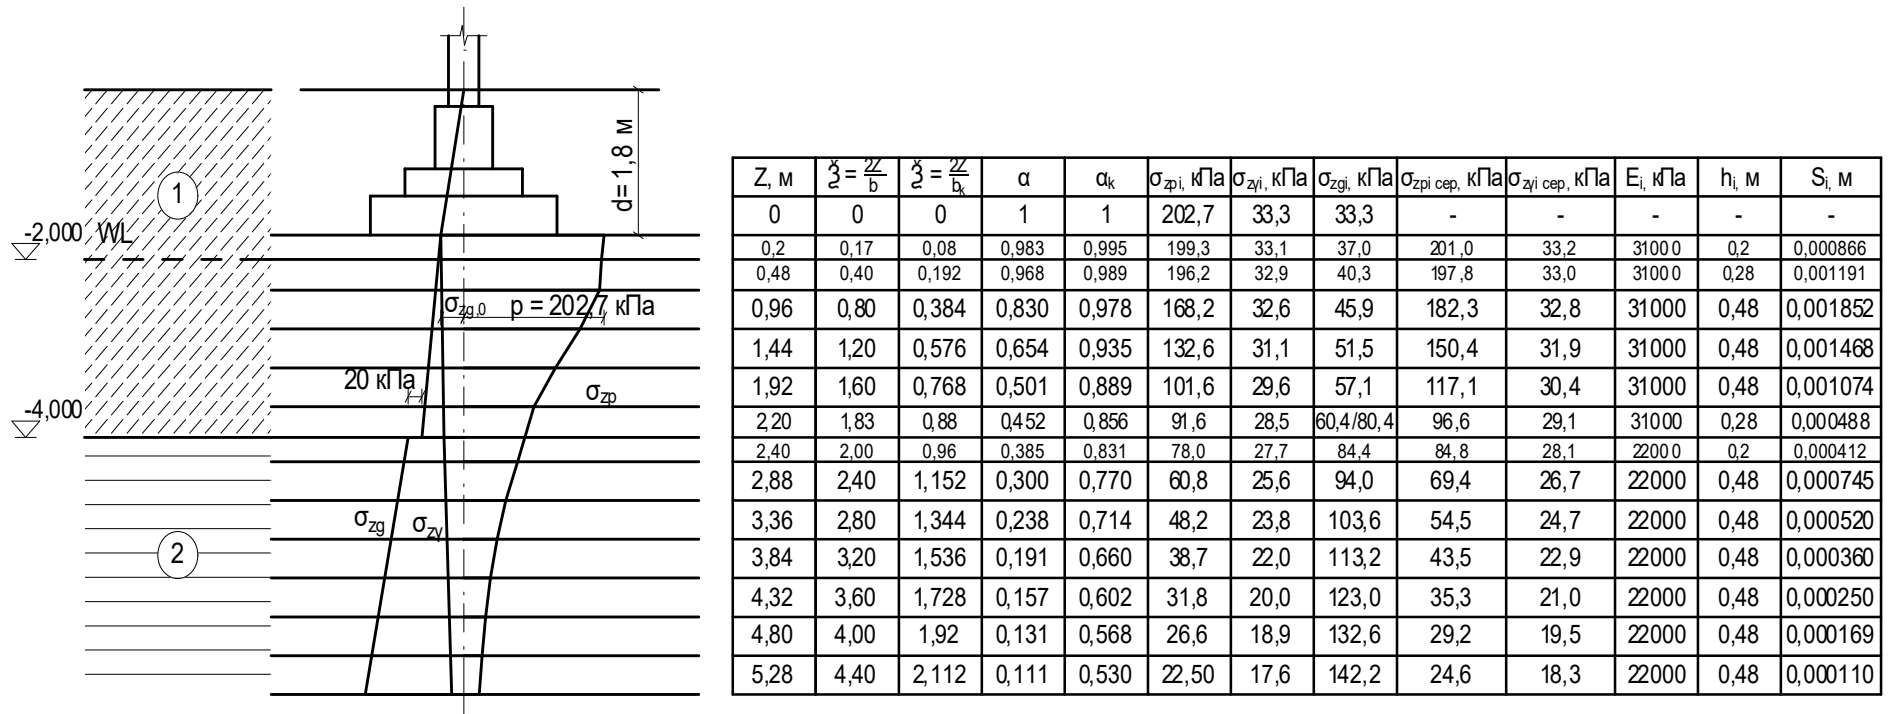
Розрахунок осідання фундаменту методом пошарового підсумовування
